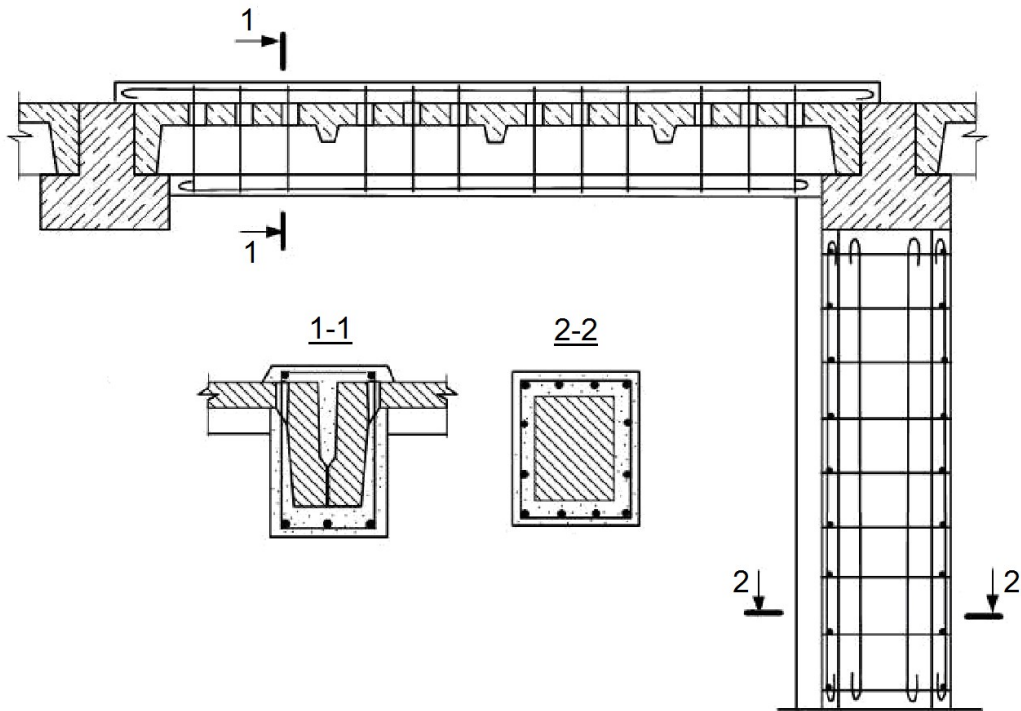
Схема підсилення монолітної балки та колони залізобетонною оболонкою
